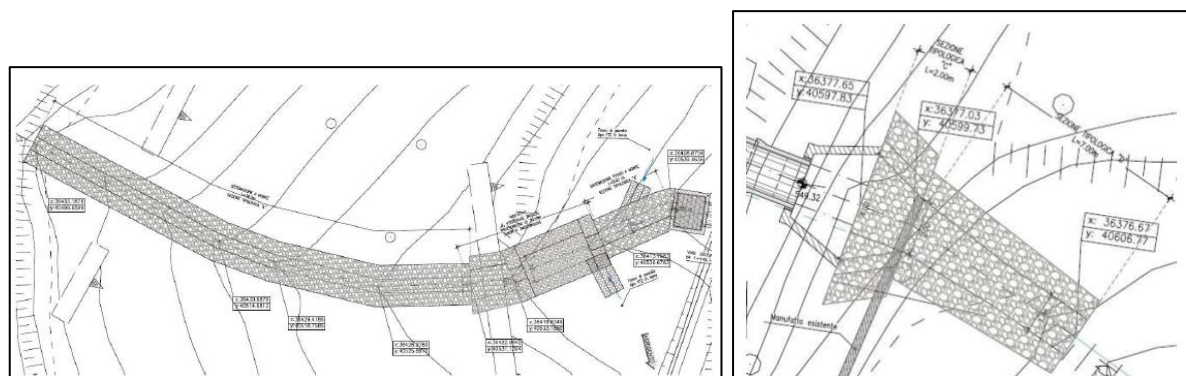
Stralcio planimetrico inalveazione a monte e a valle
